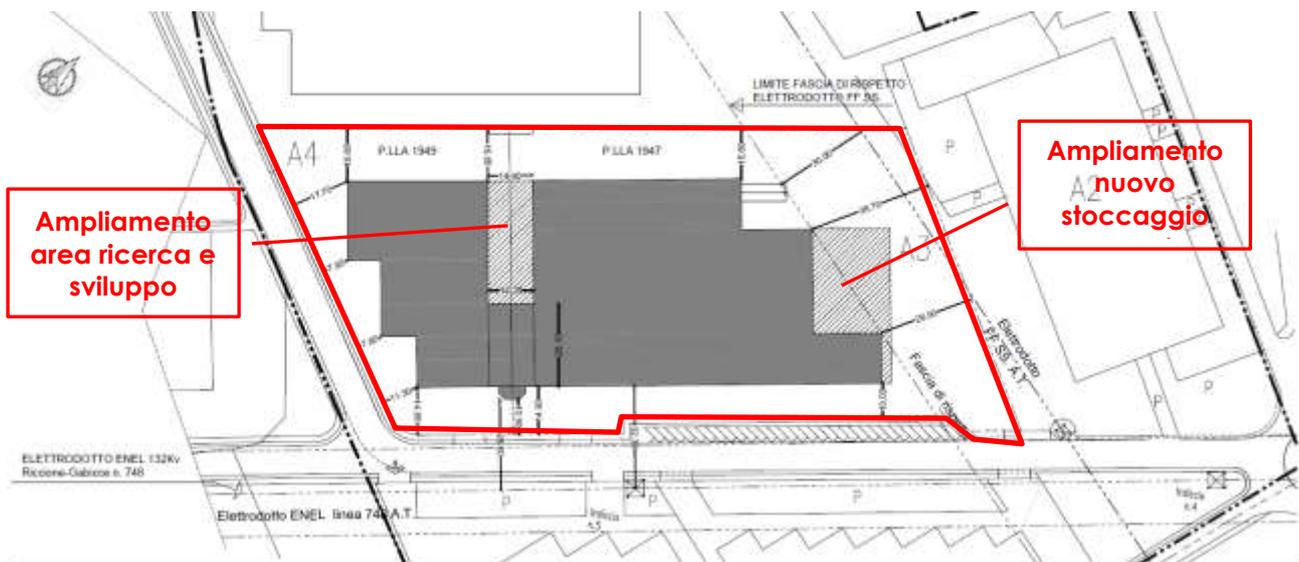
a – planimetria di progetto – nelle aree a tratteggio e nuove
